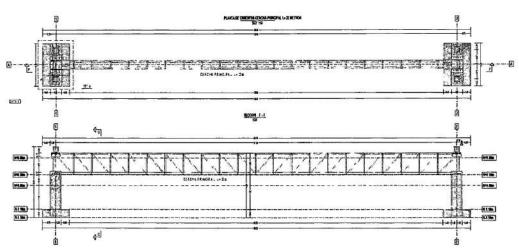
Vista en planta y perfil de estructura de paso elevado sobre Quebrada La Malena9.
